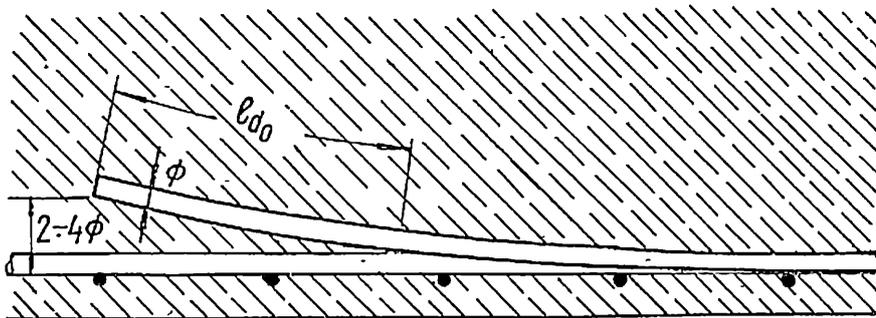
6. Отгиб концов обрываемых стержней продольной арматуры (выгодно для заделки и трещинообразования, но обычно не применяется)
